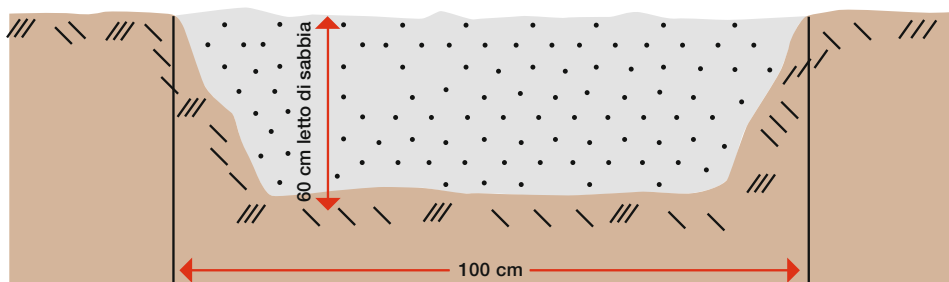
il letto di sabbia deve essere profondo 60 cm e largo come minimo 1 m.
